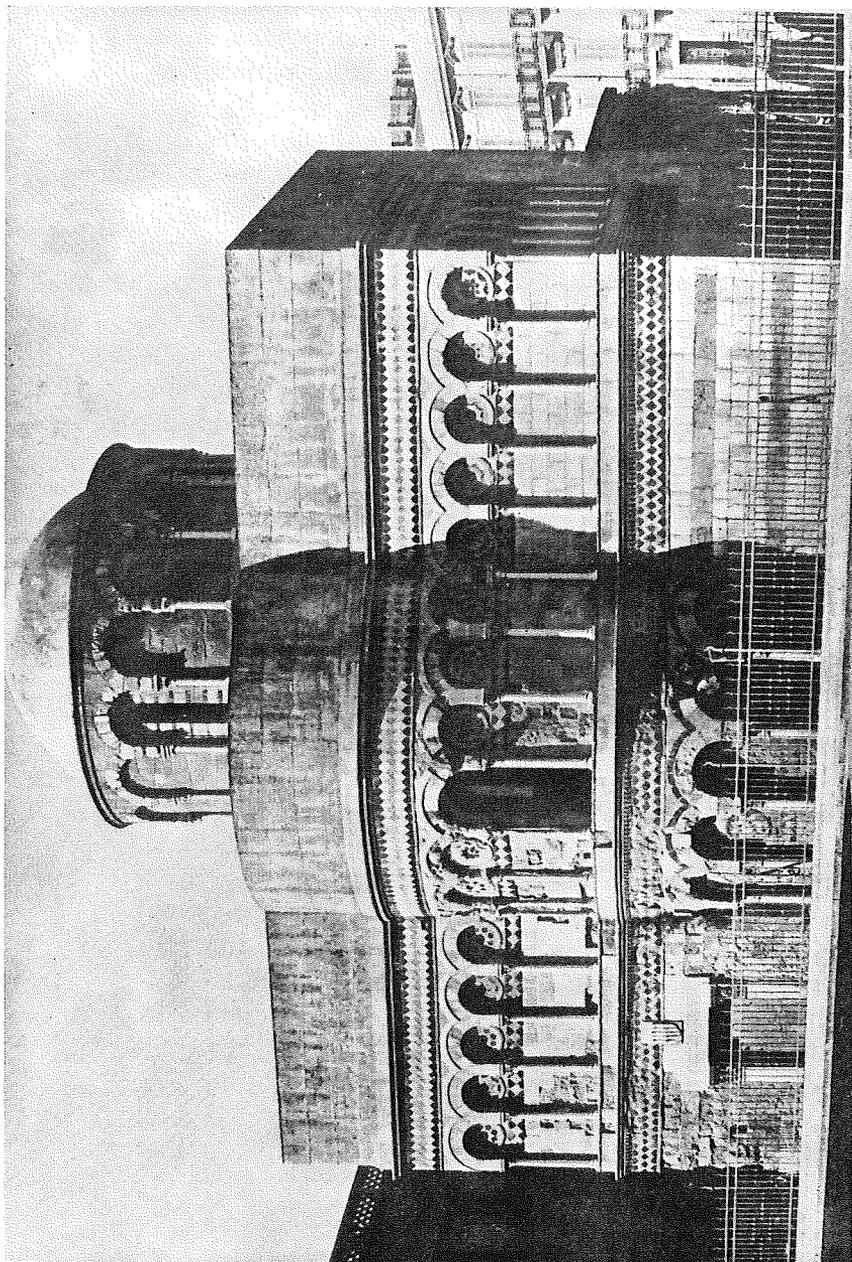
La soluzione del prospetto posteriore proposta dal Valenti.
